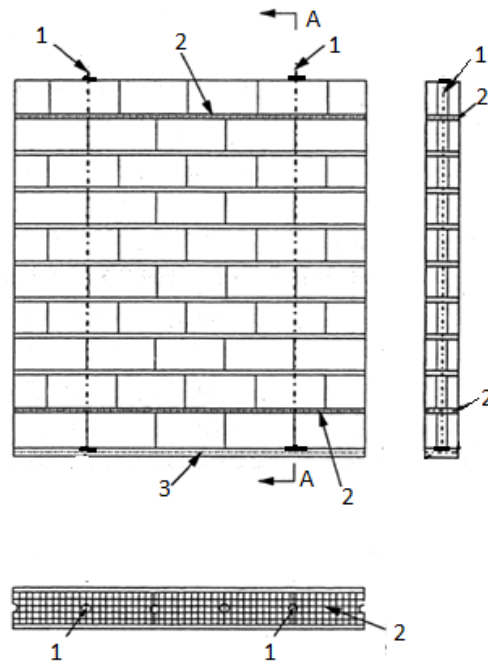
Предварительное напряжение каменной стены производственного здания, оборудованного мостовым краном [13]
